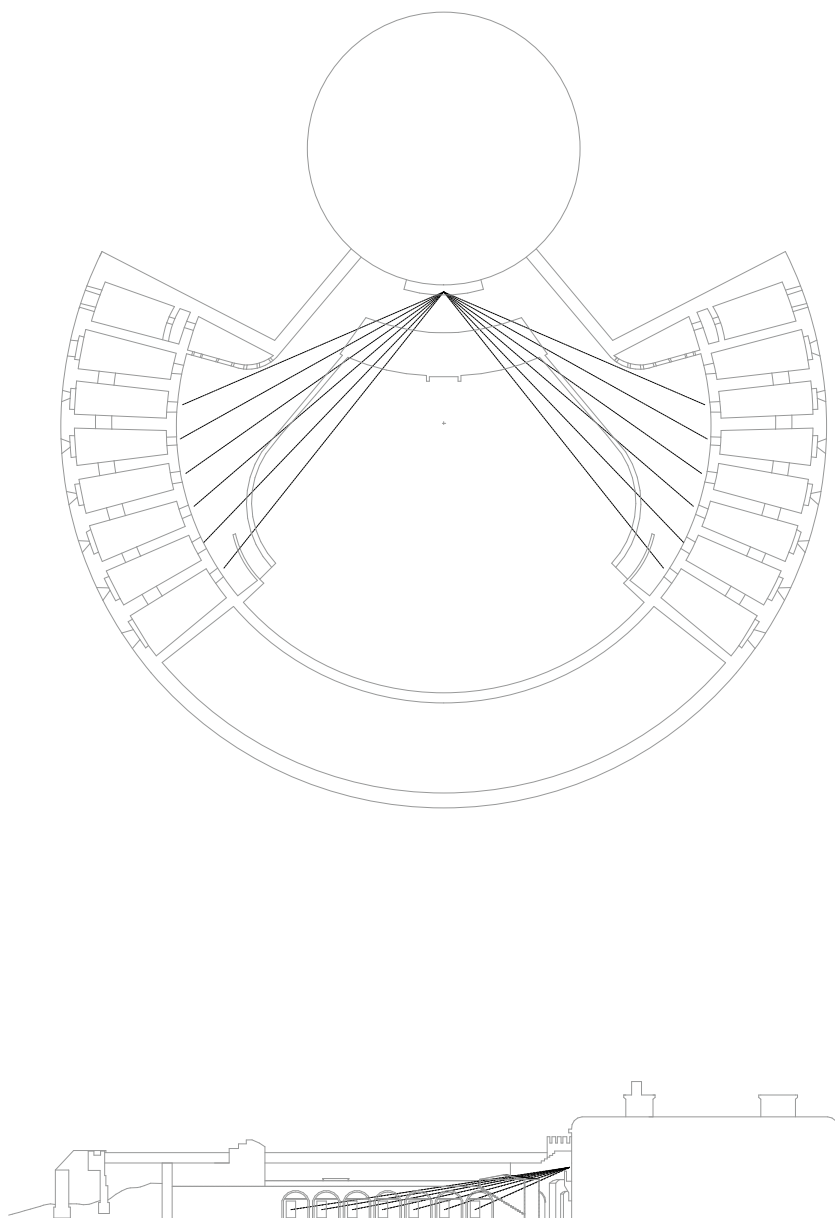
Blickachsen im Grundriss und Schnitt
